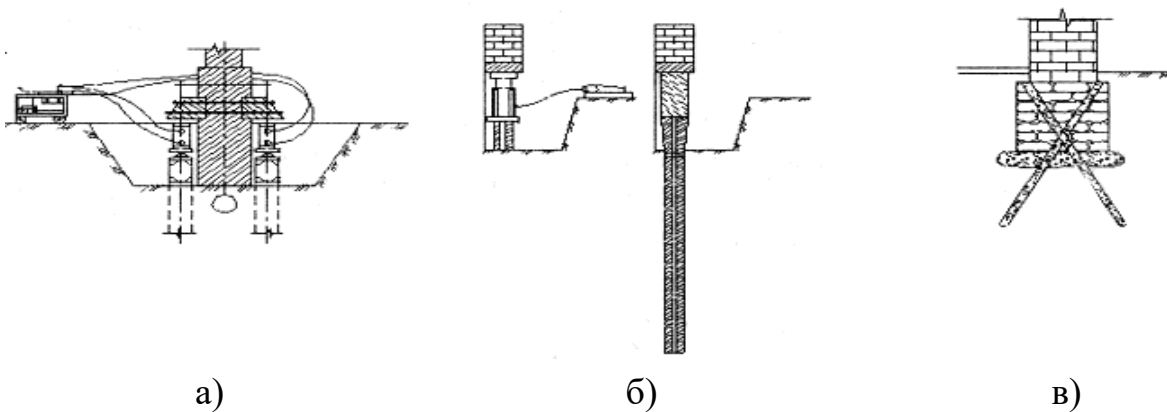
Підсилення фундаментів із застосуванням палей:
